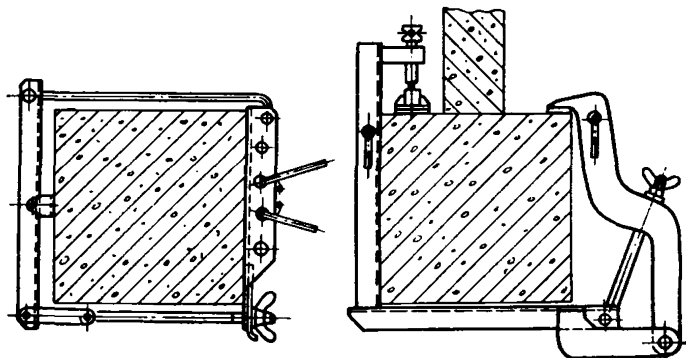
Узлы крепления хомутов к колоннам каркасно-панельного здания
